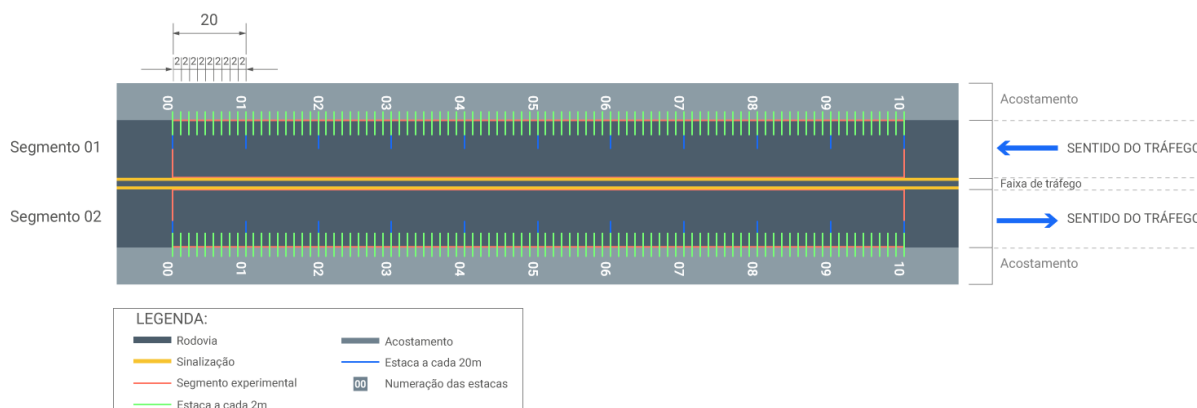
Pista simples – Marcações secundárias espaçadas a cada 2 m
